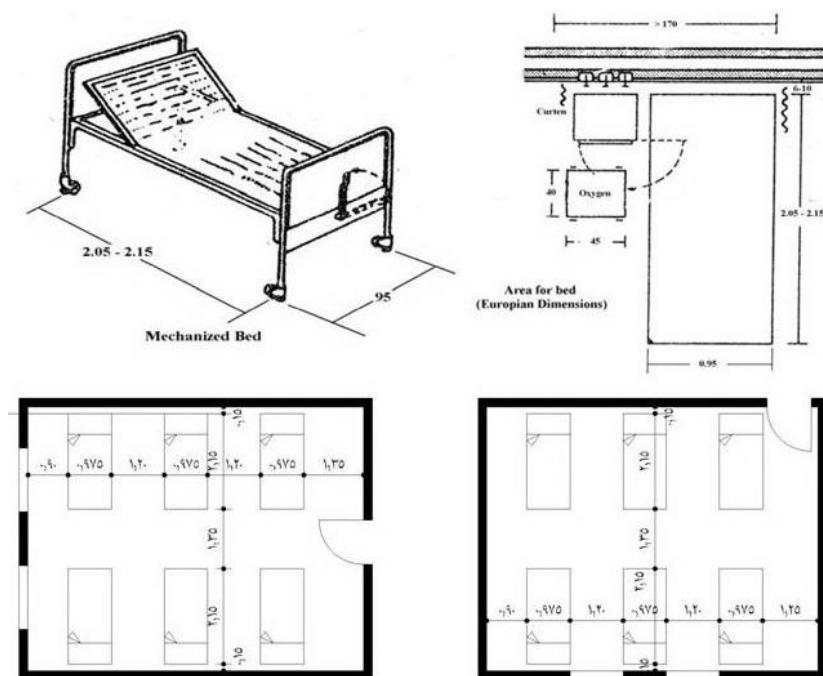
مسقط أفقي لغرفة مرضى.
